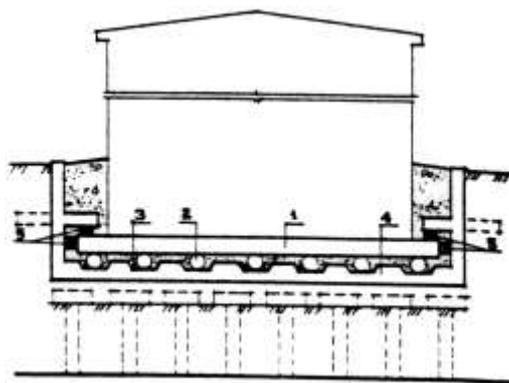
Сейсмостойкий фундамент в слабых грунтах с использованием свайного ростверка и сейсмоизолирующей подушки
